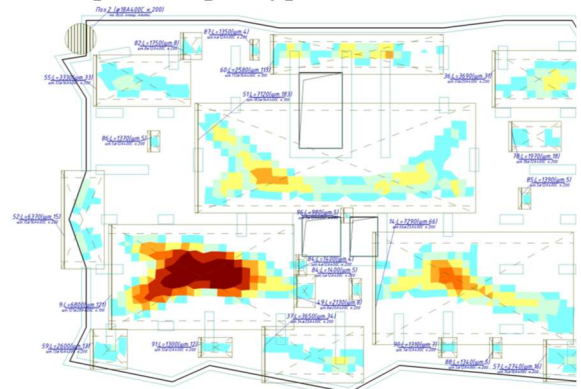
Армуння плити перекриття нижньої арматури вздовж осі Y
